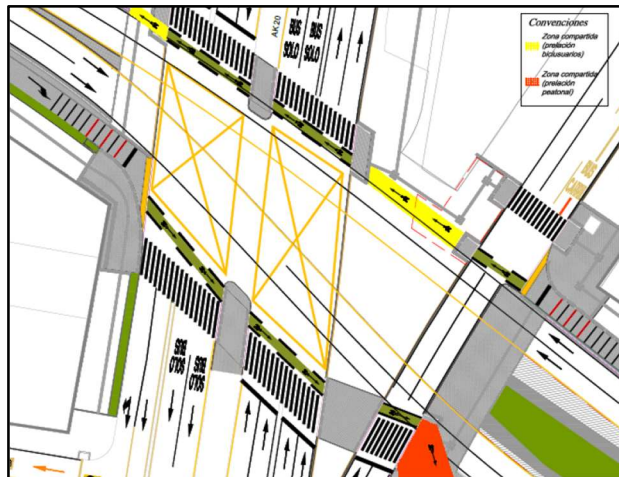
Sección transversal proyectada en la intersección Calle 72 x Av. Caracas.
